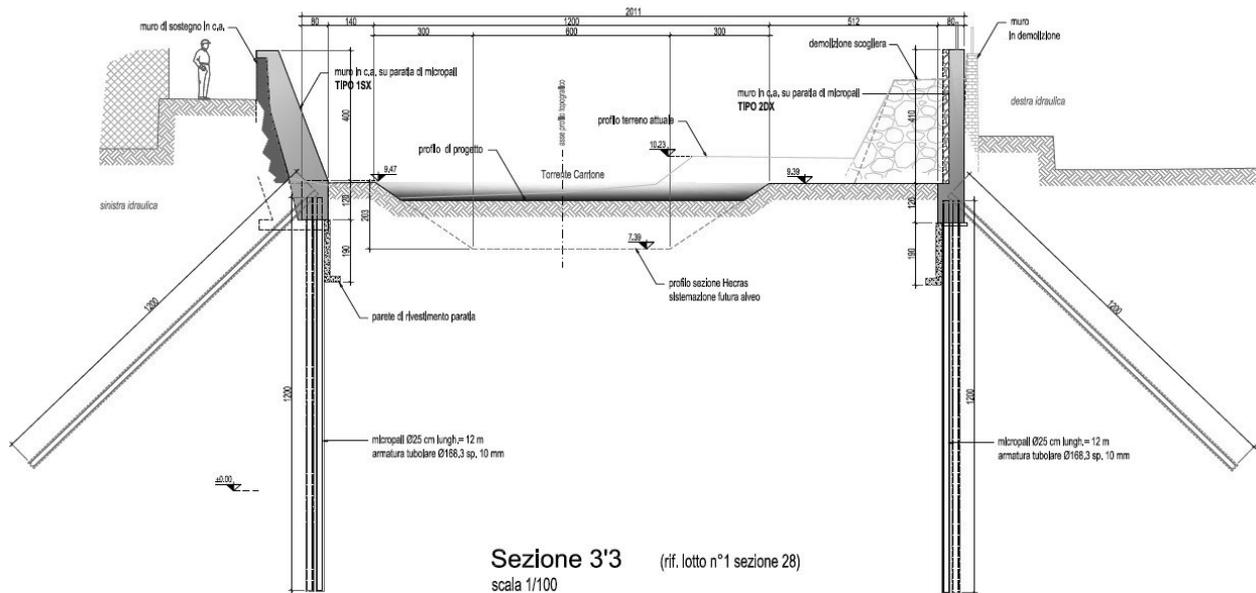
intervento di progetto in corrispondenza della sezione 28.
